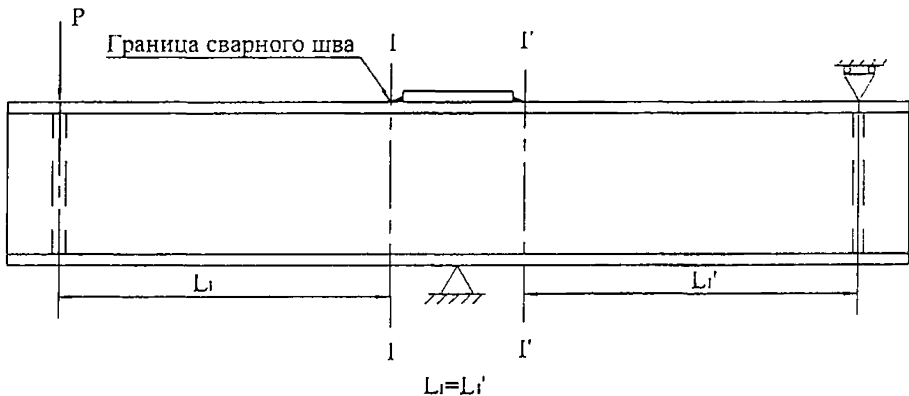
Схема нагружения типового сварного образца
